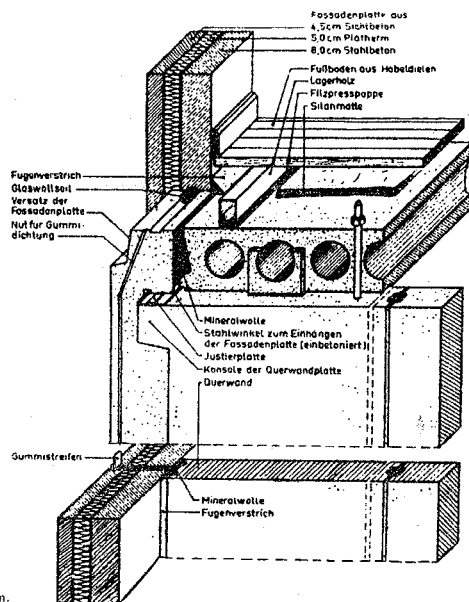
Vesterbo. Detail af facadens konstruktion.
